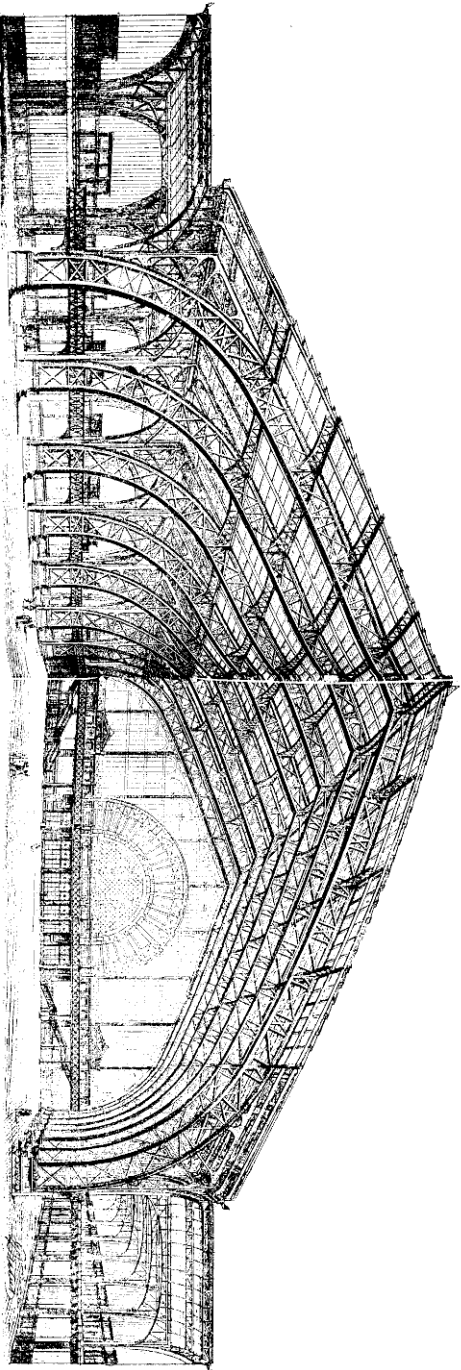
Avant-projet du Palais des Machines par M. Dauter (février 1887).
